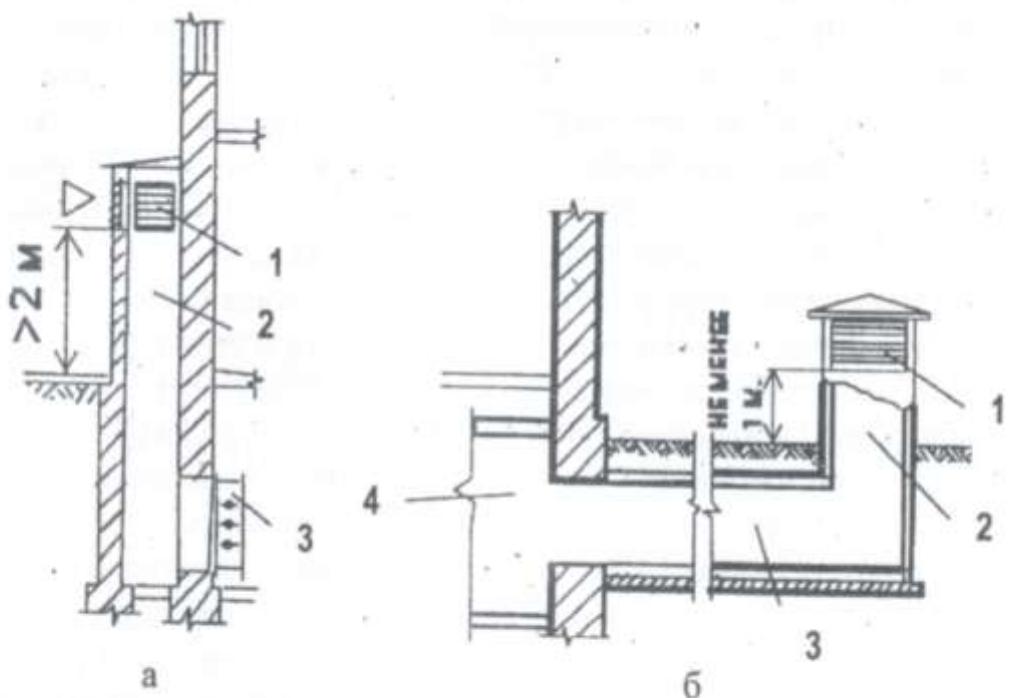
Конструкции приточных шахт: а – приставная шахта (1 – приточная решётка; 2 – вертикальный канал для подачи приточного воздуха; 3 – утеплённый клапан); б – выносная шахта (1 – приточная решётка; 2 – вертикальный канал для подачи приточного воздуха; 3 – горизонтальный подземный канал для подачи приточного воздуха; 4 – коридор наружного воздуха, к которому присоединяются приточные камеры и кондиционеры)
